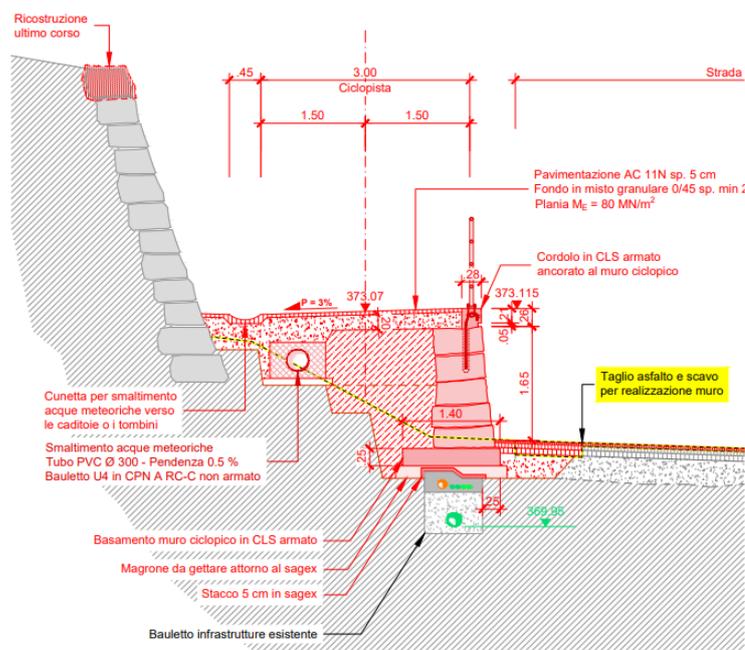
Sezione tipo su nuovo muro di sostegno (Sez. Tipo A).
